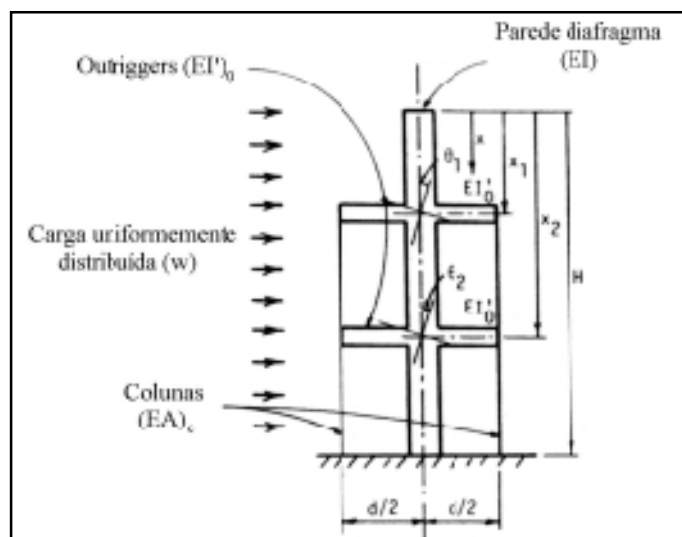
Estrutura com 2 - “outriggers” [ref. 36]
